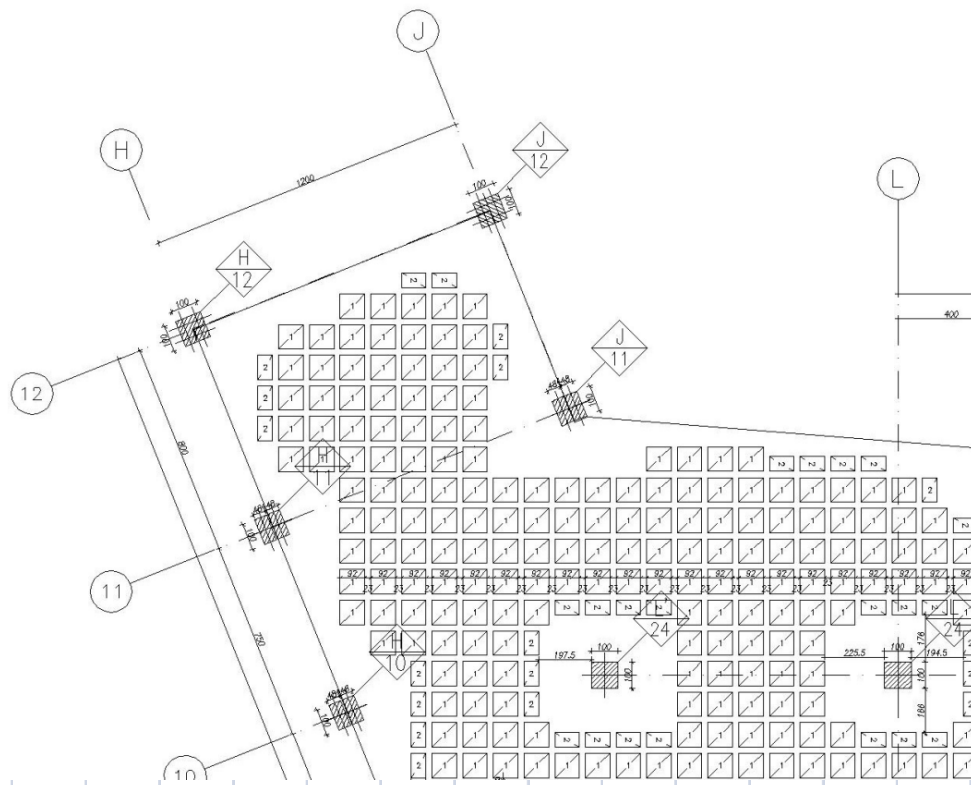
Particolare della pianta del corpo 2, primo piano, alleggerimenti
